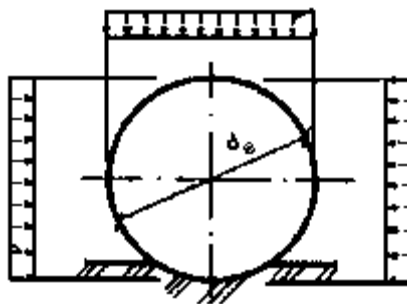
Схема нагрузок на трубопровод от давления грунта и нагрузок, передающихся через грунт
